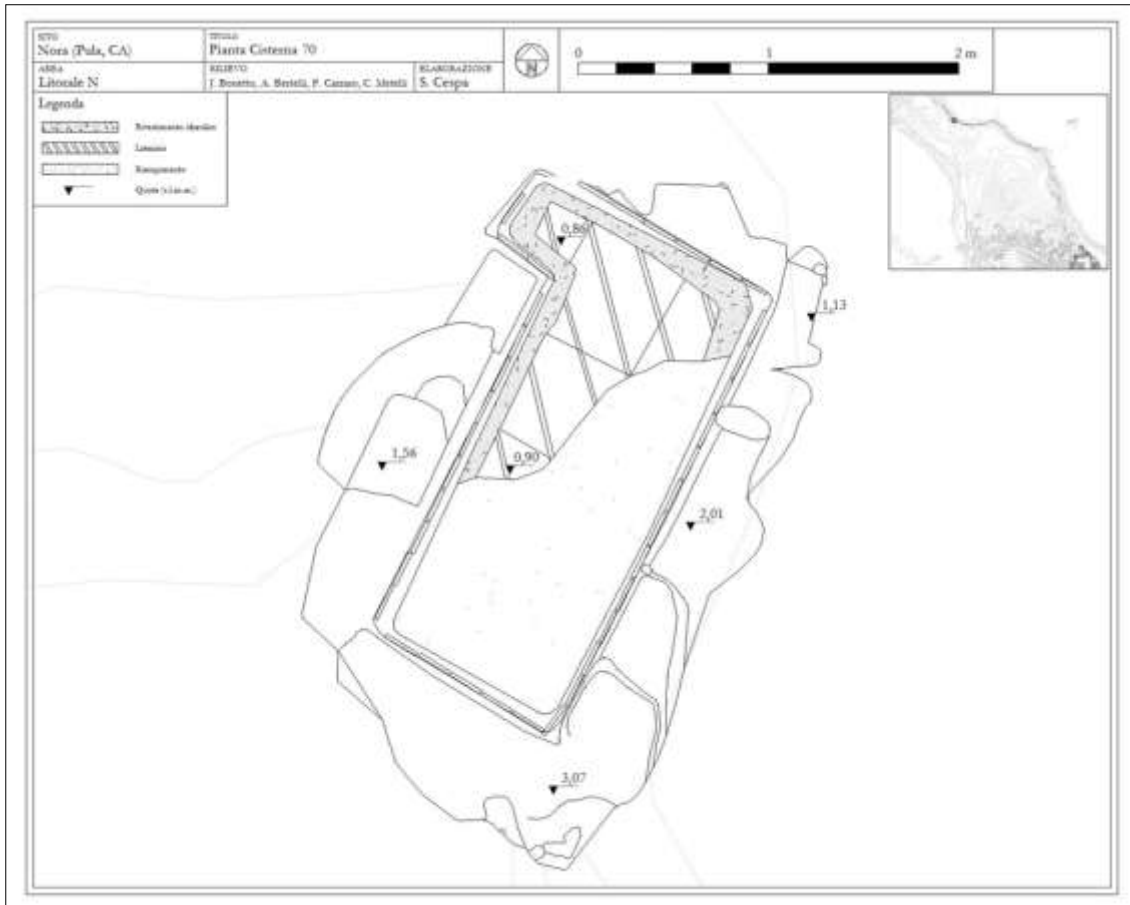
Pianta della cisterna 70 (elaborazione dell'autore).
